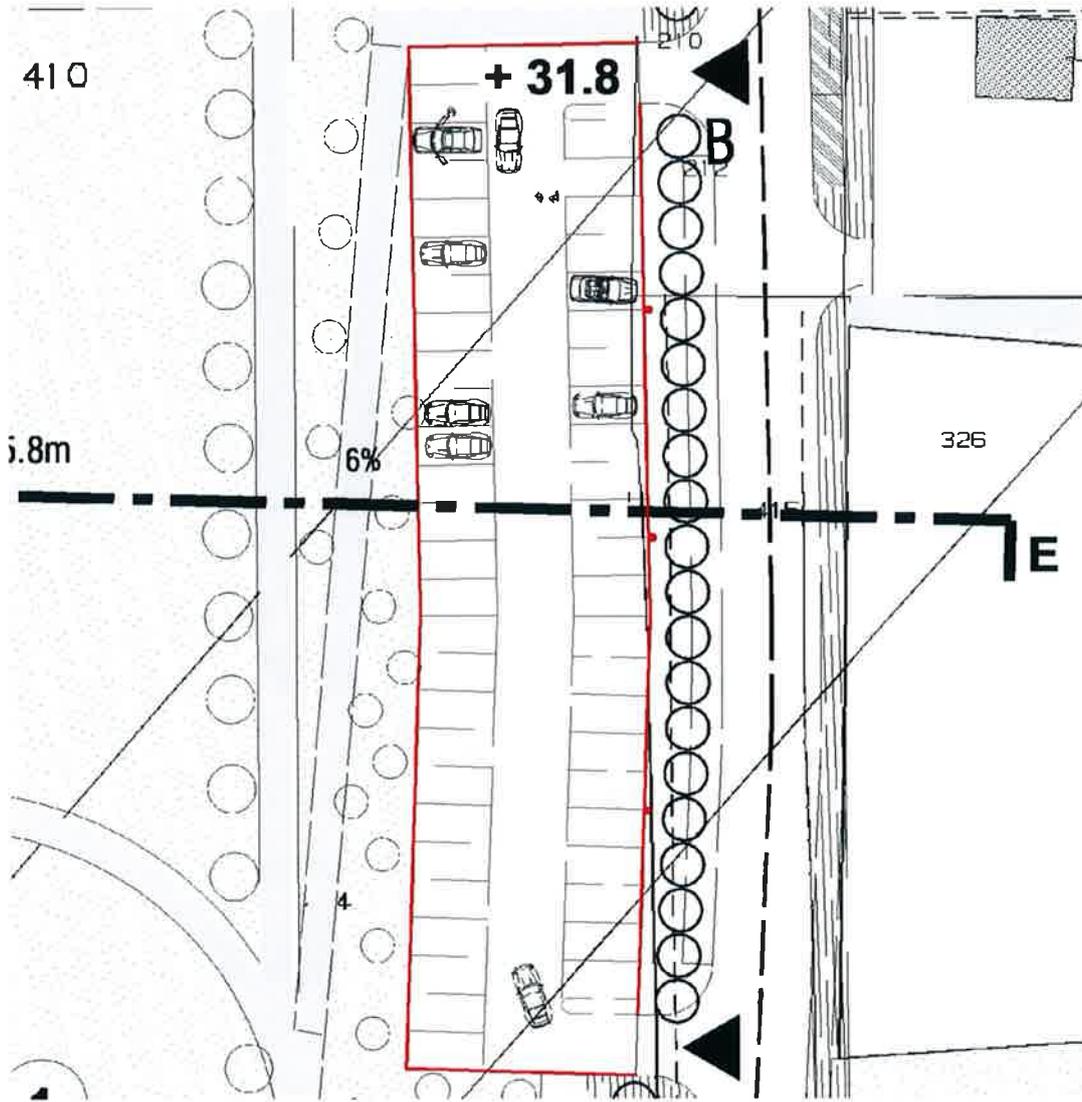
Inquadramento planimetrico dell'opera pubblica n. 6_ scala 1:500.
